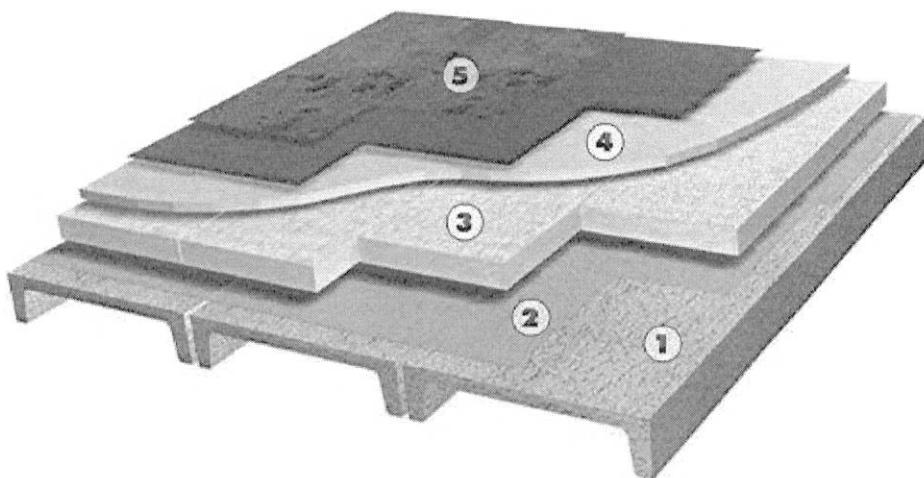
Структура плоской кровли: 1 – плиты покрытия; 2 – слой пароизоляции; 3 – слой утеплителя; 4 – железобетонная стяжка; 5 – слой гидроизоляции (рулонной или наплавляемой)
